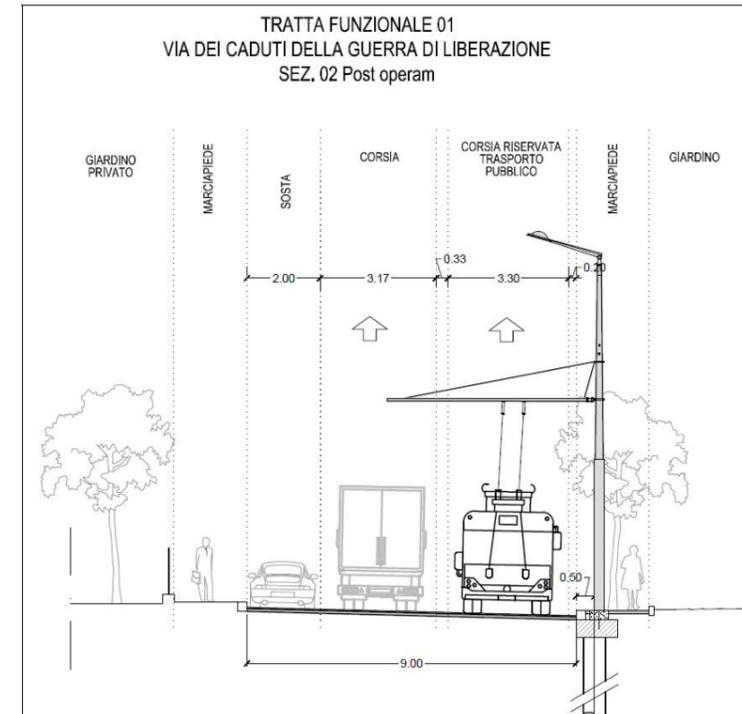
Sezione trasversale di progetto viale dei Caduti della Guerra di Liberazione
